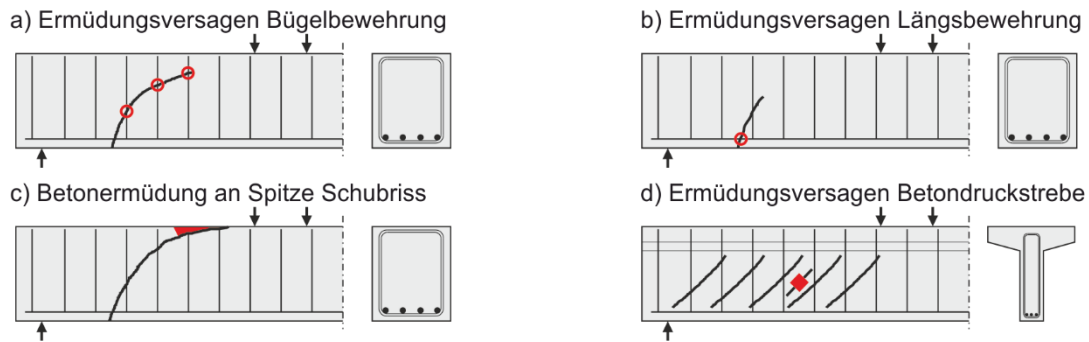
Versagensarten Stahlbetonträger mit Querkraftbewehrung unter Betriebsbeanspruchung (nach /RILEM94/)
